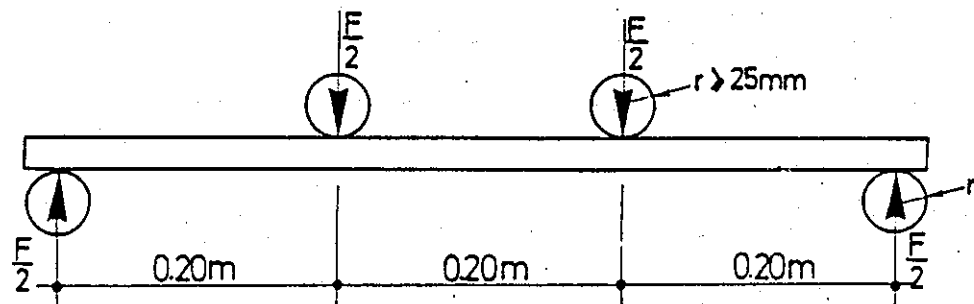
ESSAIS DE FLEXION SUR LAMELLES
